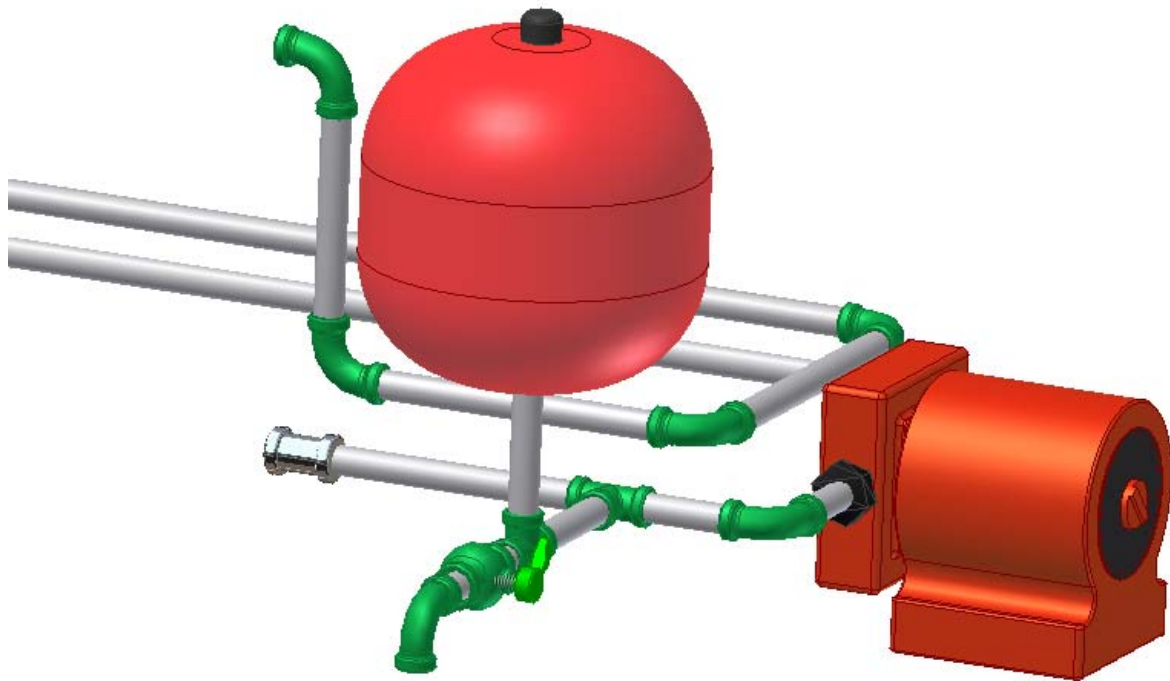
Montajul pompei de recirculare și a vasului de expansiune pentru circuitul cu panourile solare.
